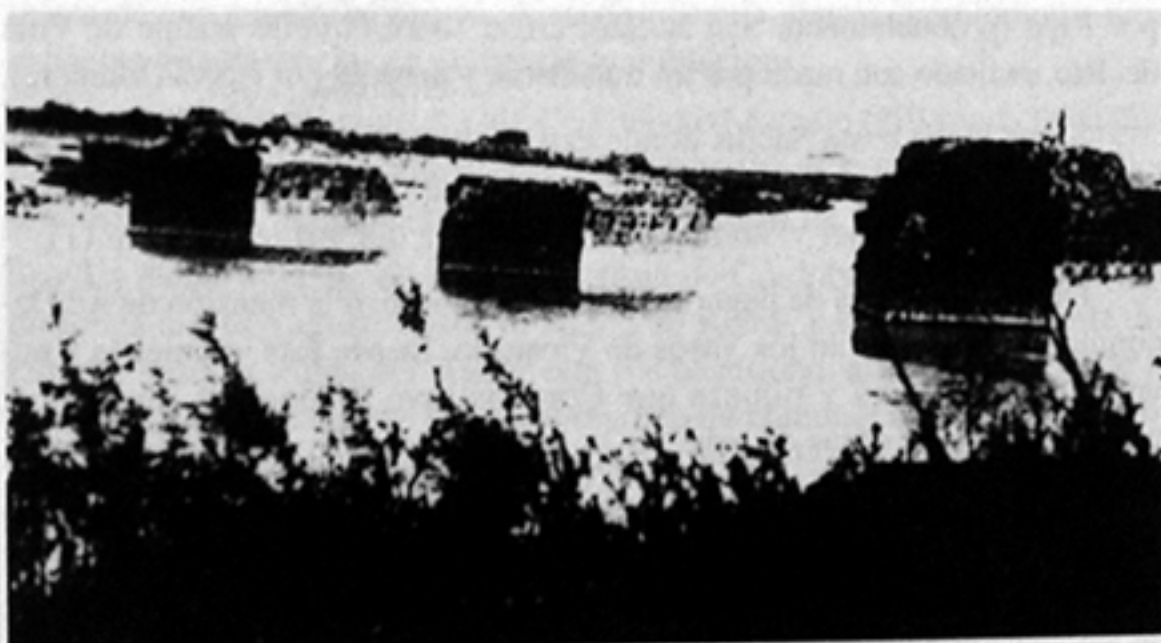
Puente de Lituergo en Villanueva de la Reina. Pilas vistas desde aguas abajo.
